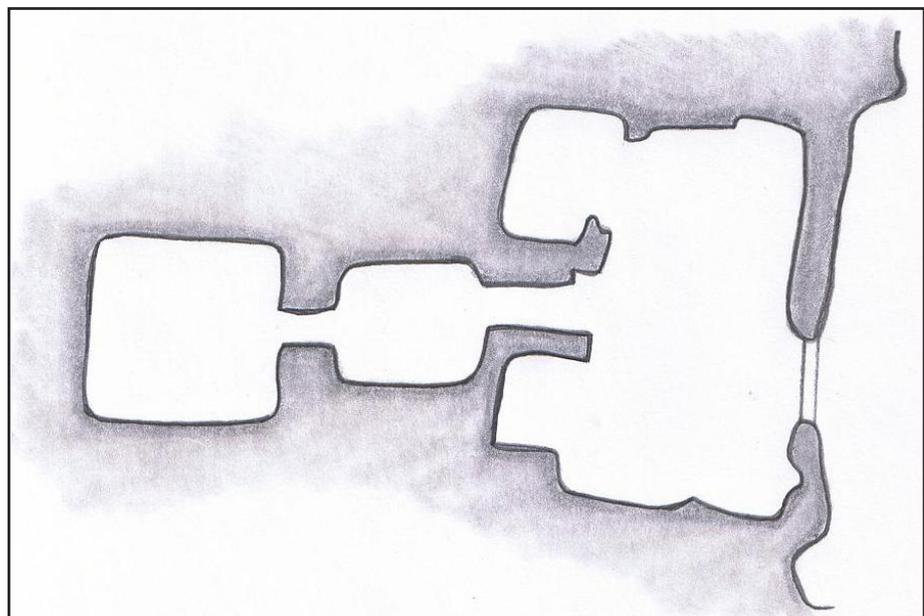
, planta tipo de una cueva de la segunda tipología. Imagen de autor (2014). Fuente: elaboración propia
